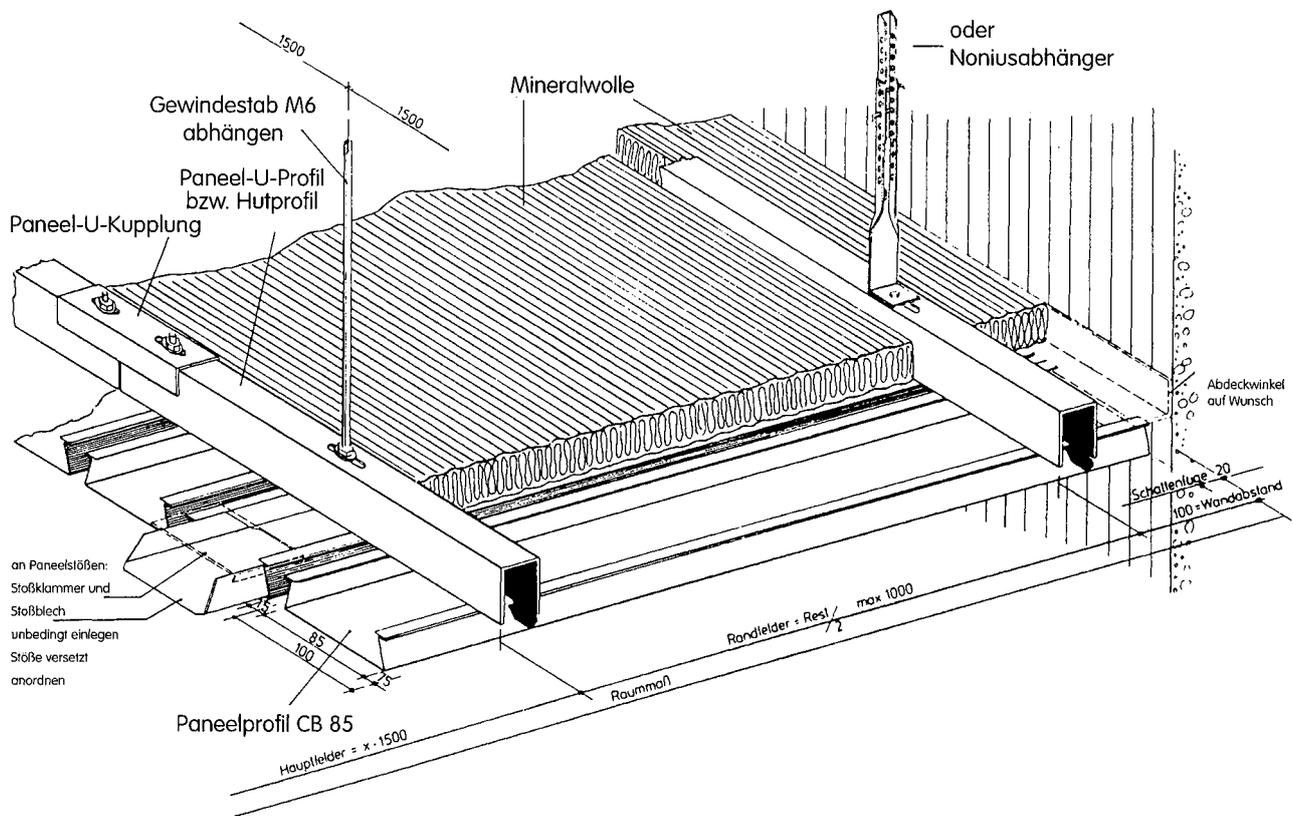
Schnitt durch eine fertig montierte unbeheizte ballwurffeste Paneel-Decke
